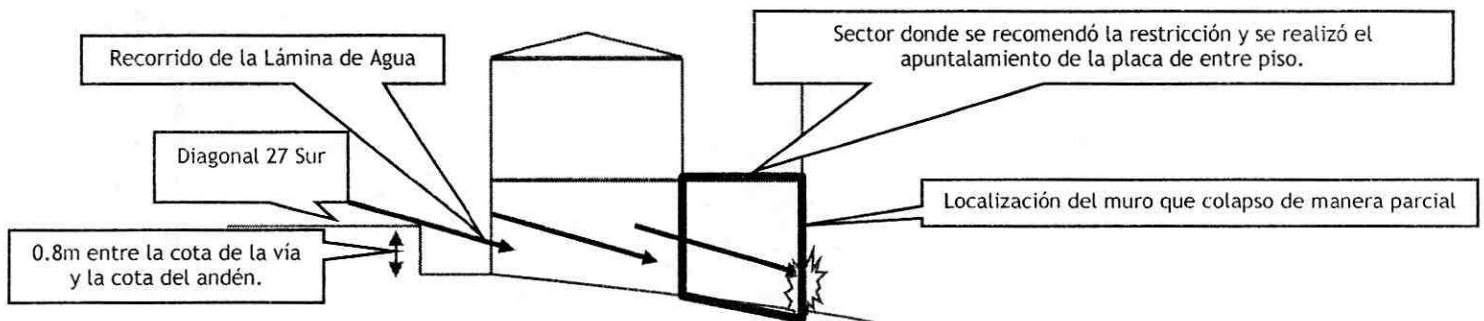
Esquema de la vivienda y la localización del muro colapsado de manera parcial.
